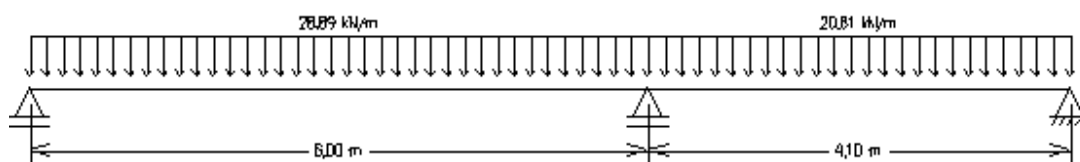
Esquema estrutural dos esforços sobre a viga 15.
